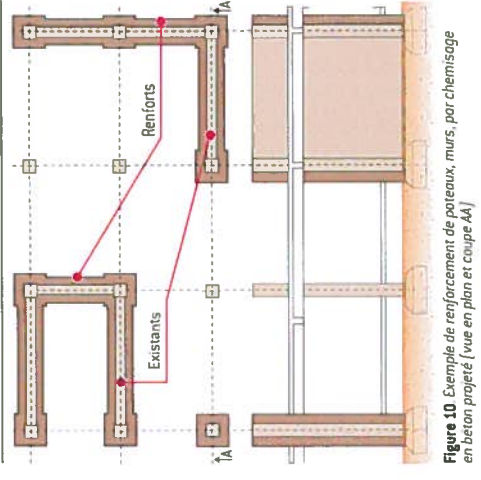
Exemple de renforcement de poteaux, murs, par chemisage en béton projeté (vue en plan et coupe AA)
